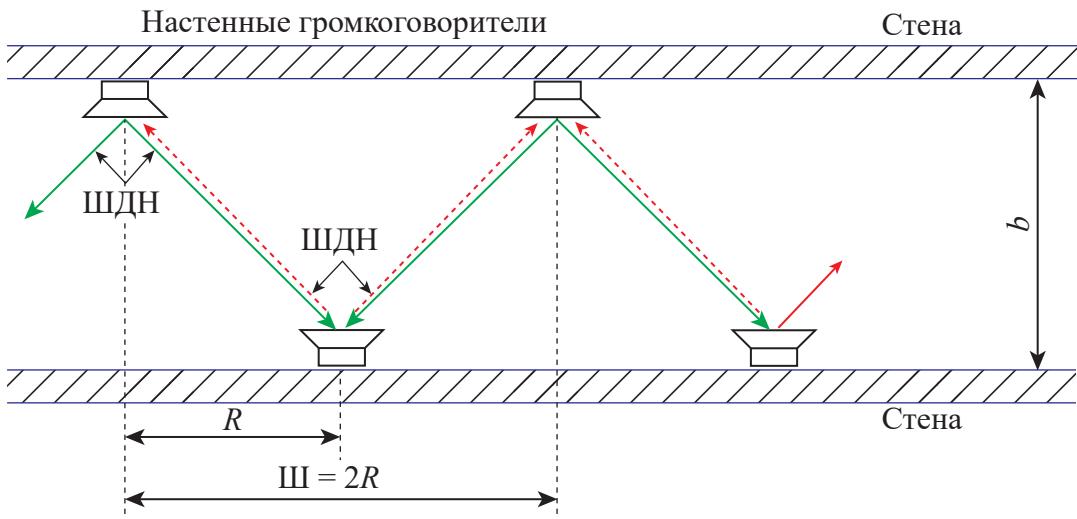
Расстановка настенных громкоговорителей в прямоугольных помещениях с размещением вдоль двух противоположных стен в шахматном порядке:
